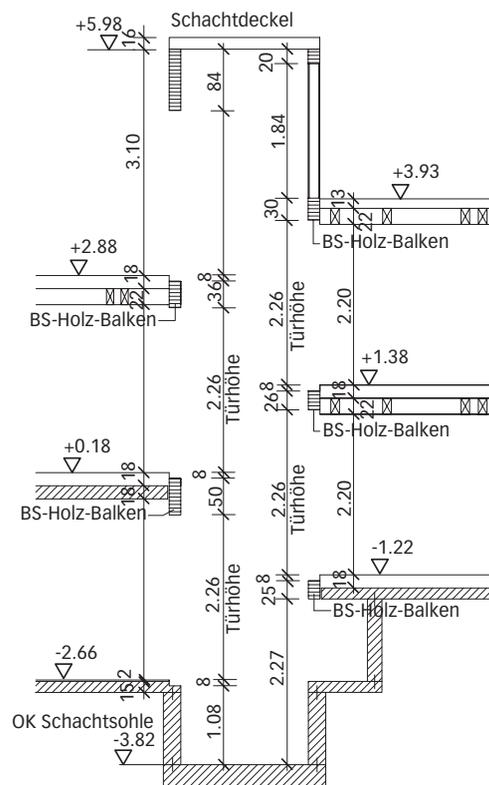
Schnitt durch den Aufzugsschacht im Gebäude, mit betonierter Unterfahrt
